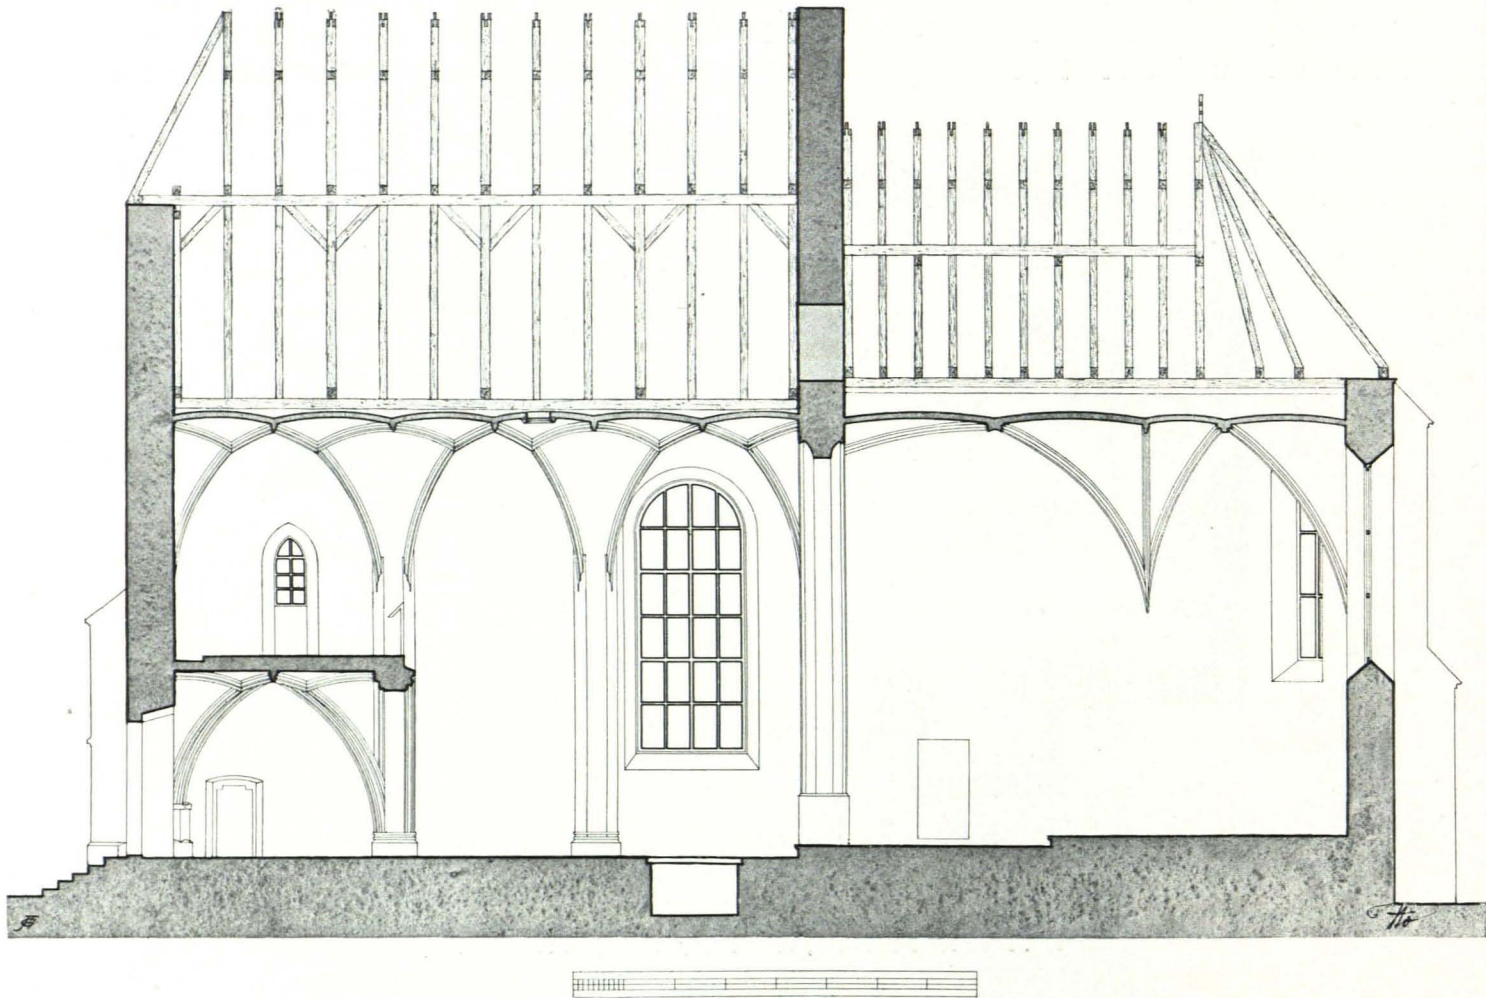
Klein-Pöchlarn, Pfarrkirche, Längenschnitt 1:150 (S. 158)
